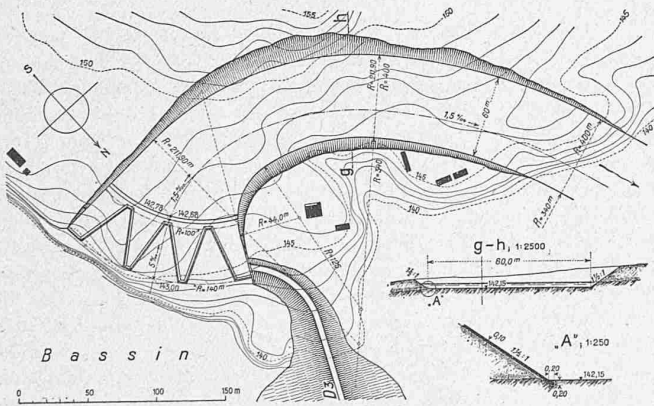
Ueberlaufwerk mit Ableitungskanal. — Lageplan 1:5000.
